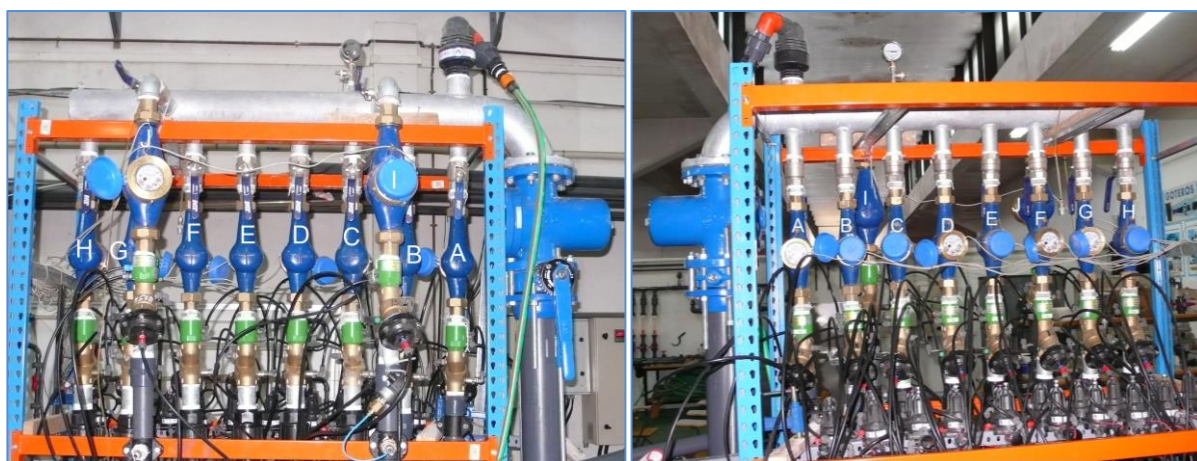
Hidrante V1-2 C.R. San Isidro y Realengo 2010. Tipo 4.(Fotos Miranda M., Balbastre I.). Poco espaciamento entre tomas, ventosa sin válvula de aislamiento y filtro caza piedras mal colocado.
